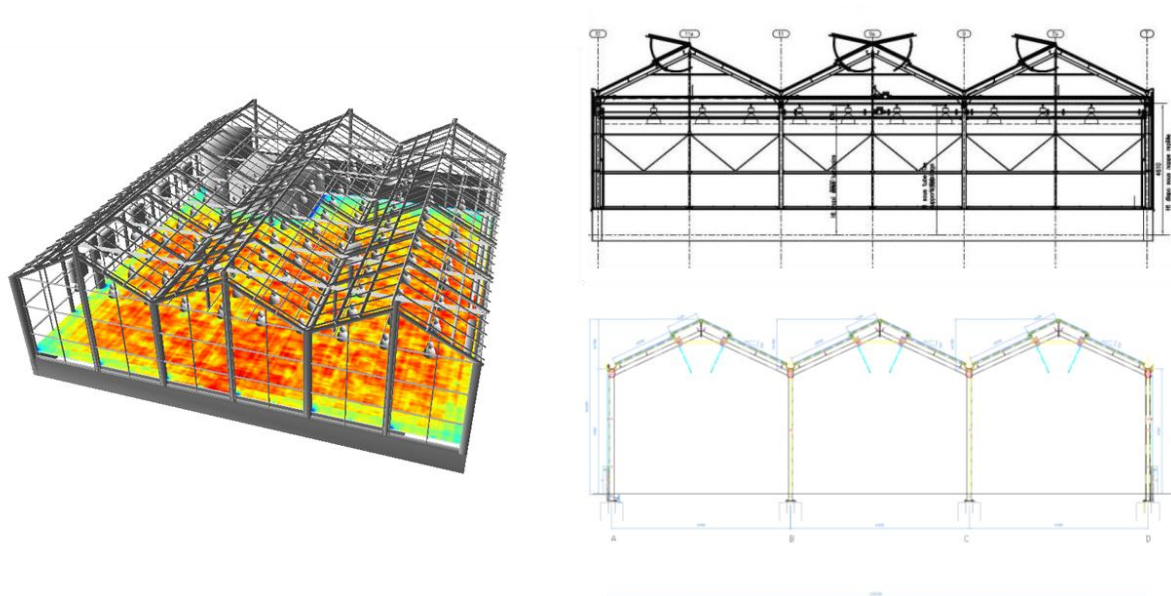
Maquette 3D, coupes de la façade et chapelles de la serre PHENOARCH et image d'expérimentation vigne
